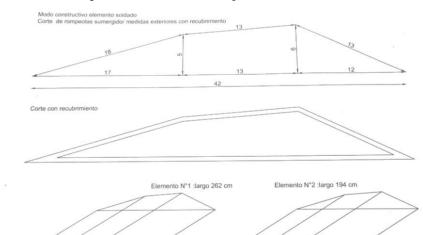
Plano de construcción de los rompeolas sumergidos del modelo marítimo. Fuente propia
